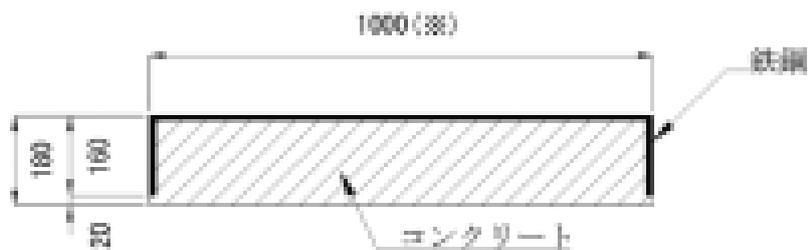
セグメント標準断面図 (円周方向) (鉄鋼コンクリート造)
